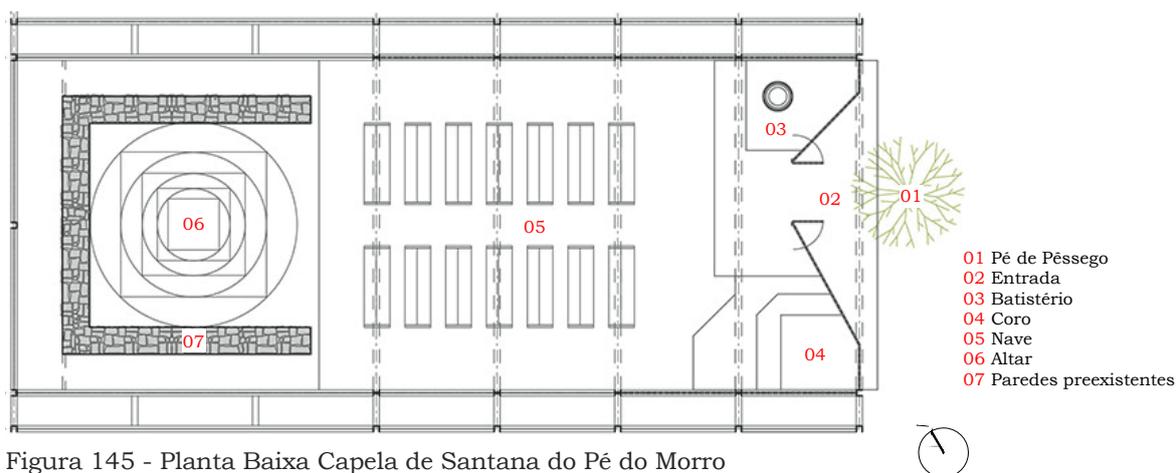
Planta Baixa Capela de Santana do Pé do Morro
